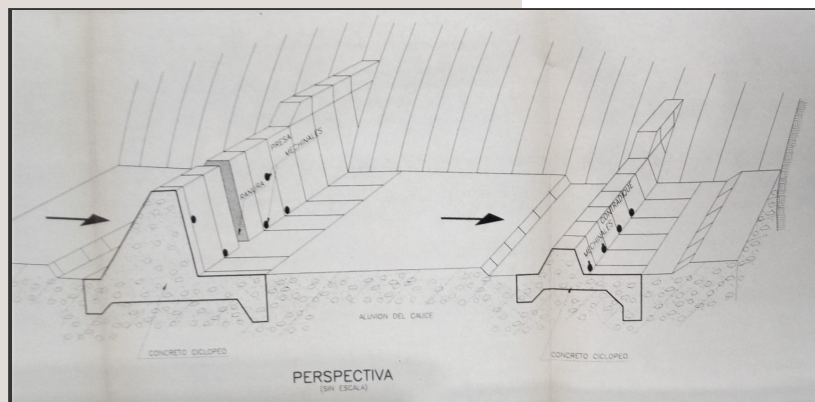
Perspectiva de la presa abierta de concreto ciclópeo sobre el río Naiguatá. Fuente: PROHIDRA (2001a).
